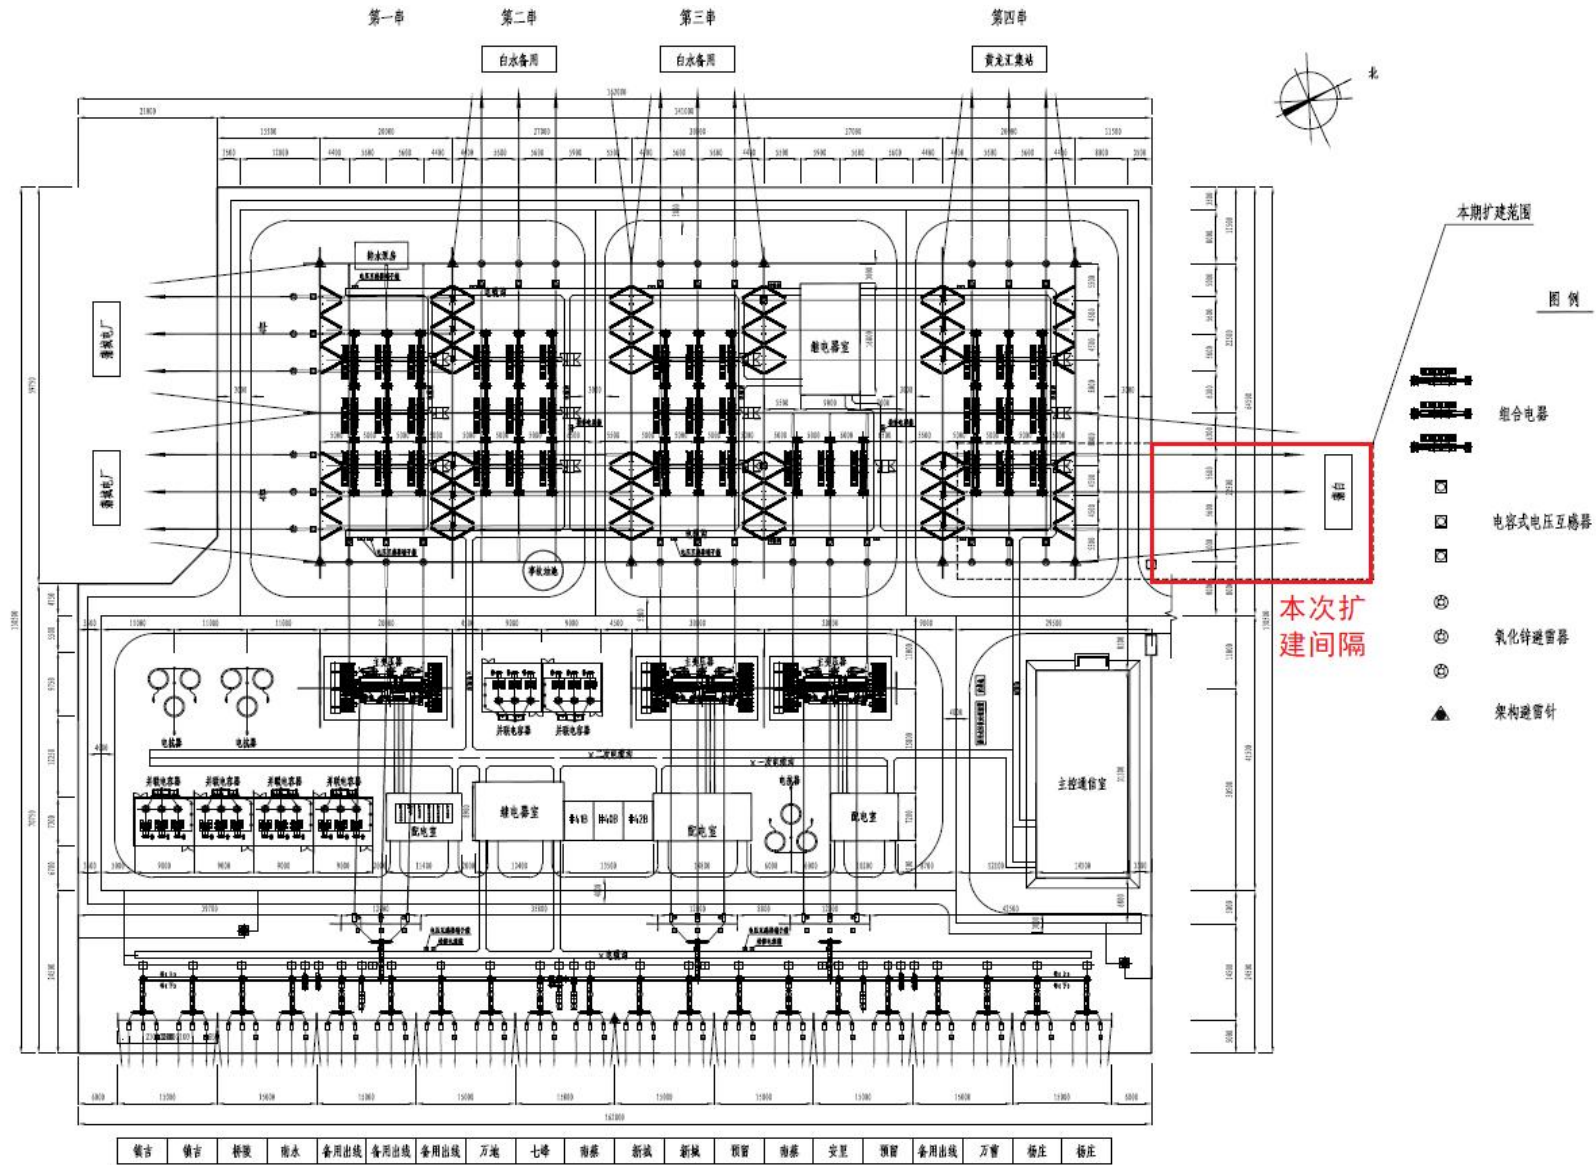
万泉330kV变电站出线间隔扩建工程平面布置图
